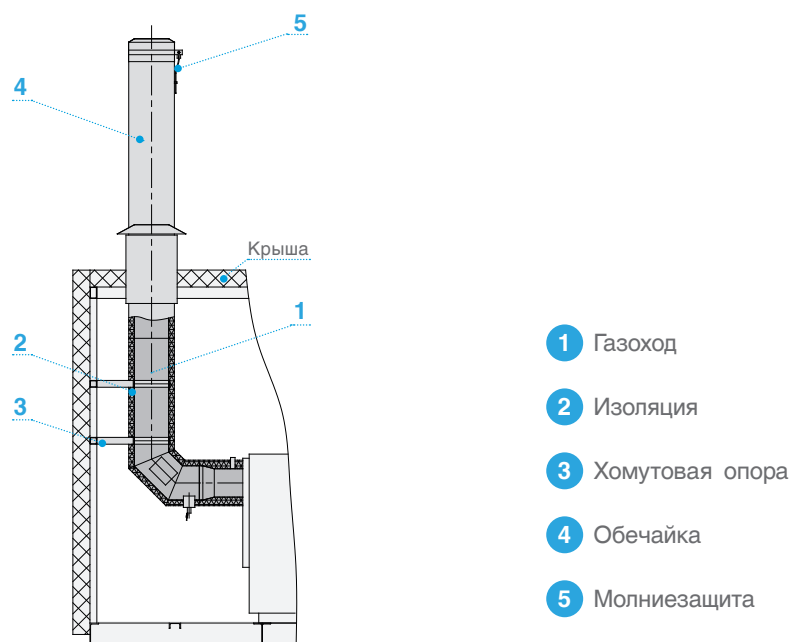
Схема конструкции дымовой трубы крышного типа
